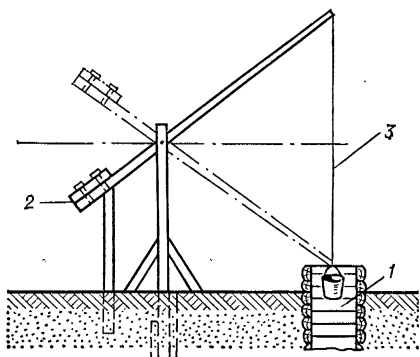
Схематическое изображение «журавля» для шахтного колодца: 1 — колодец; 2 — противовес; 3 — веревка с ведром.
